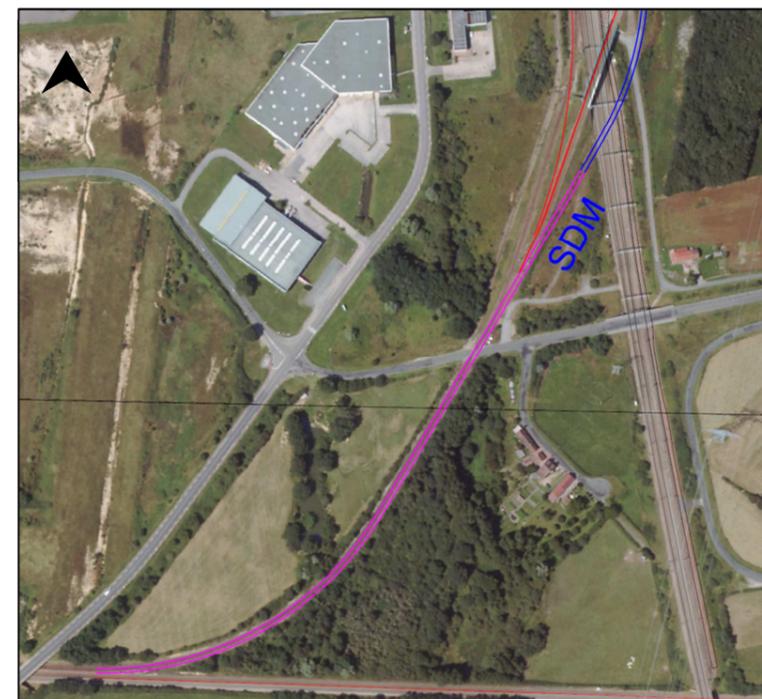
reprise partielle de la voie travaux (Fond Orthophoto RFF)
